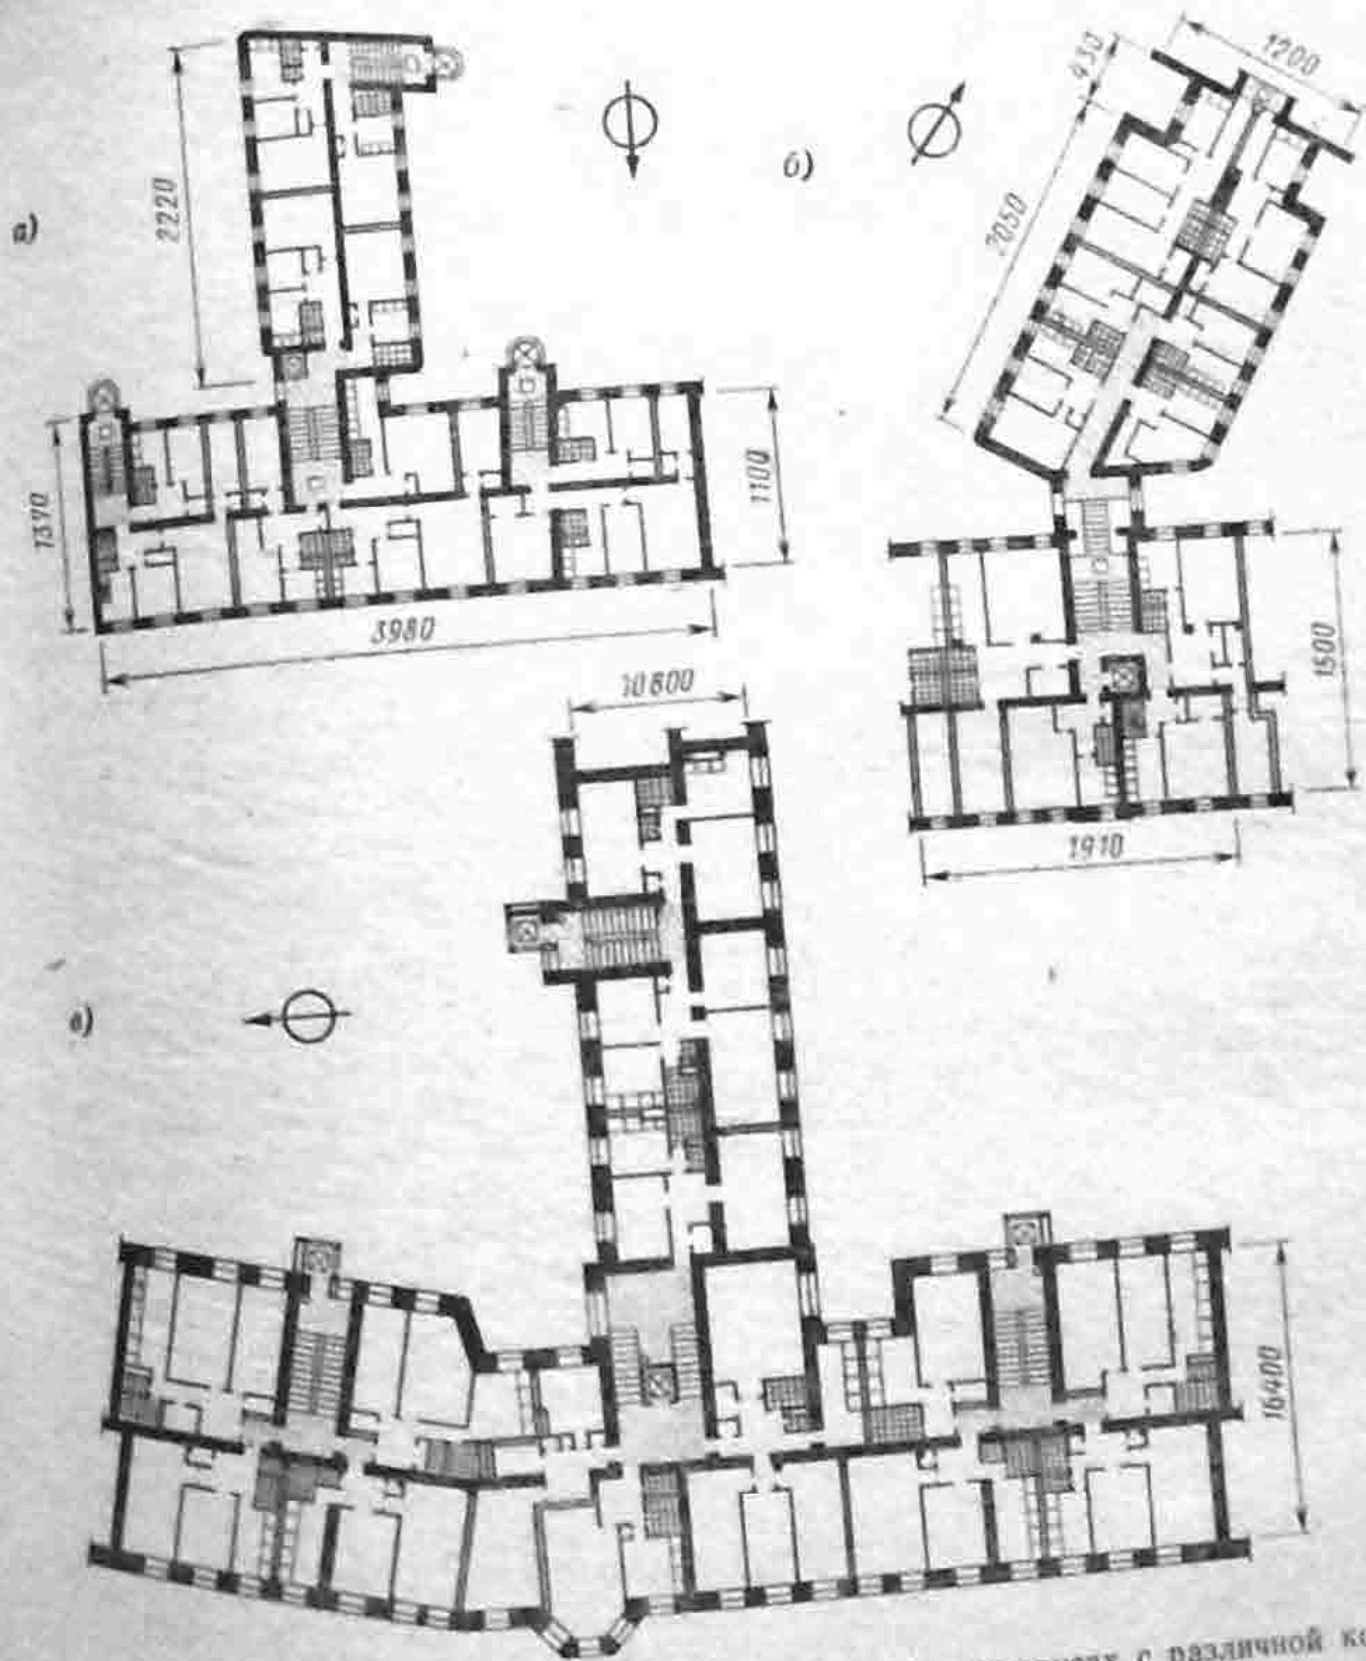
Примеры модернизации Т-образных секций в корпусах с различной конструктивно-планировочной схемой
